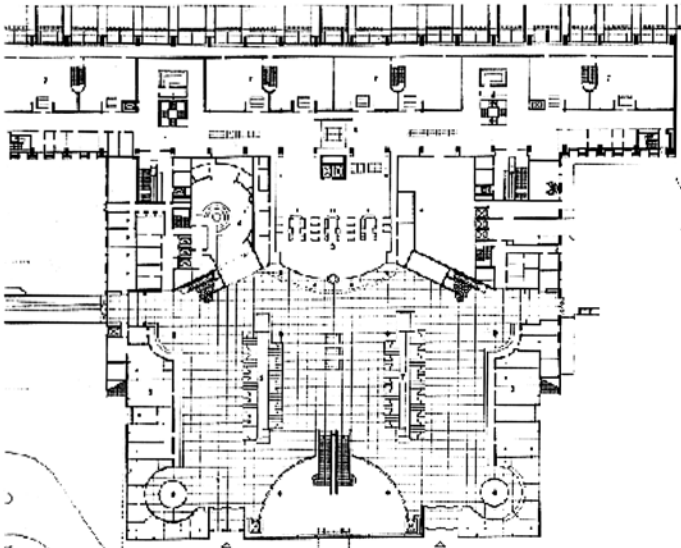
Planta arquitectónica aeropuerto Stuttgart
